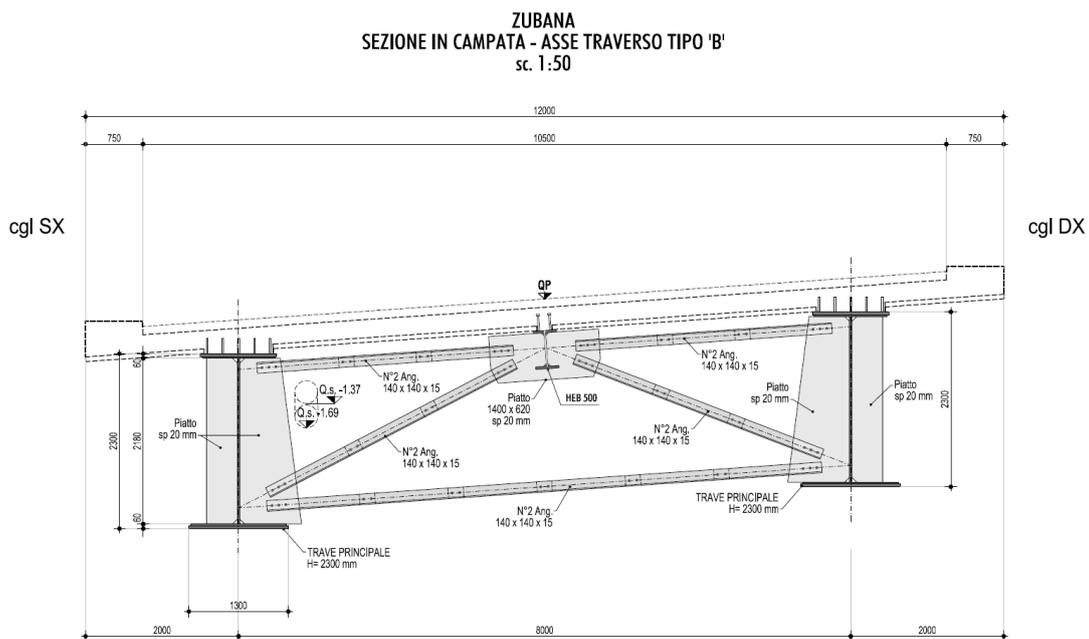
SEZIONE TRASVERSALE IMPALCATO IN CAMPATA
